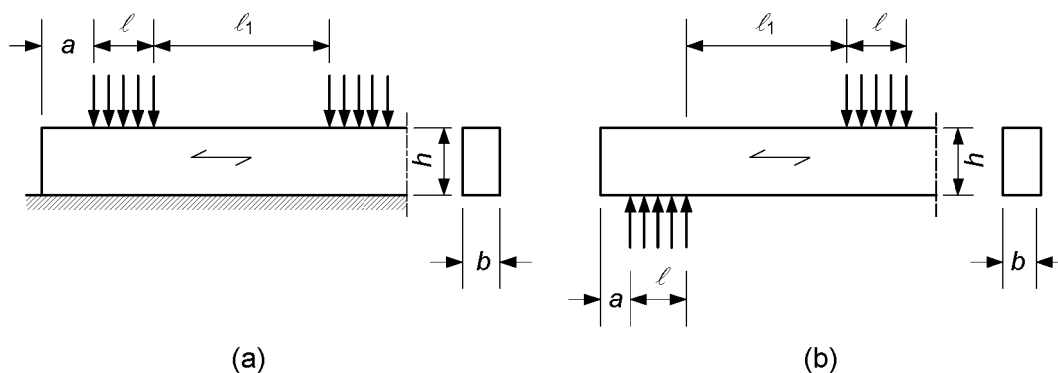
Pieza (a) sobre apoyo en continuo y (b) sobre apoyos aislados
